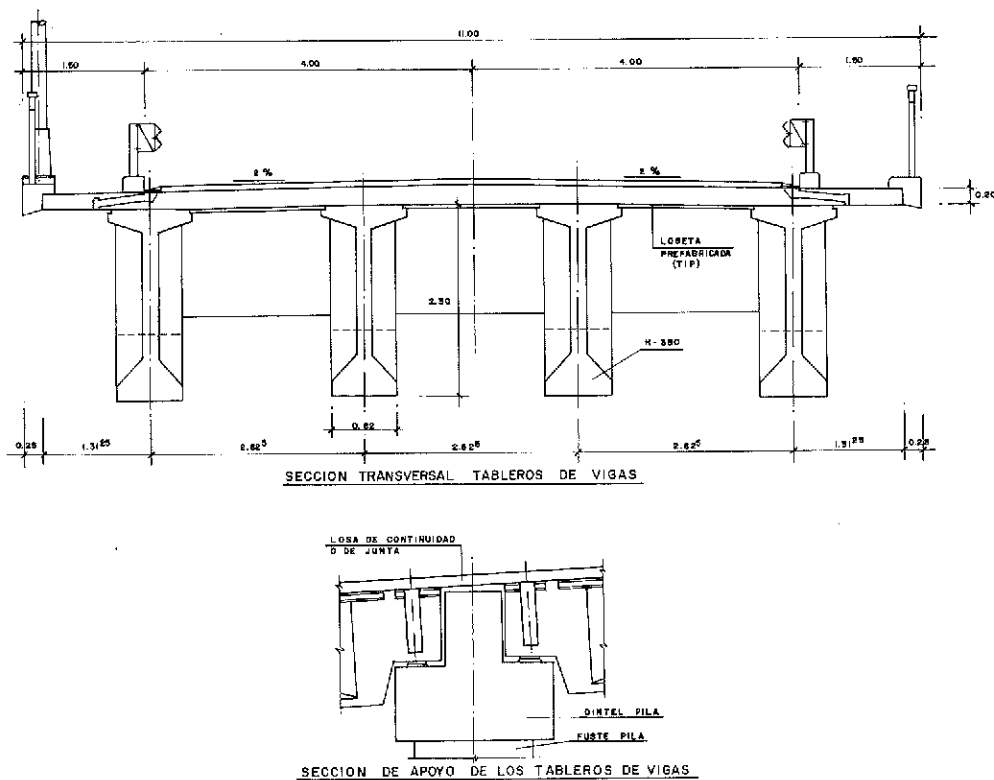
Sección transversal tableros de vigas y de apoyo.
